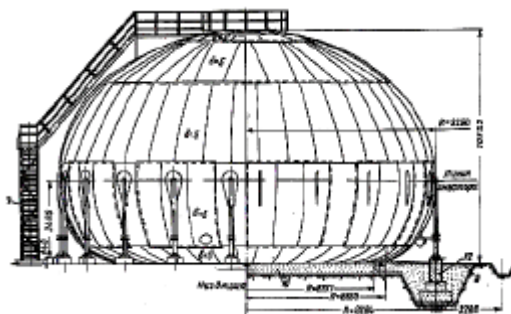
Осесиметричний краплеподібний резервуар з екваторіальною опорою
